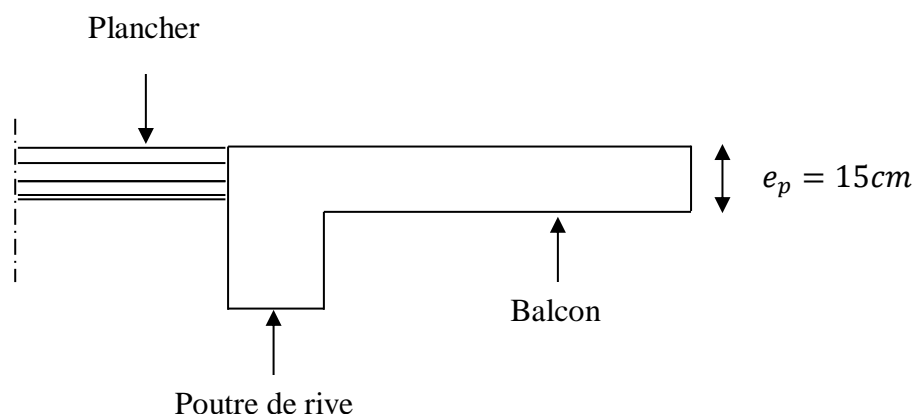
Coupe verticale détaillant la liaison balcon – poutre.
